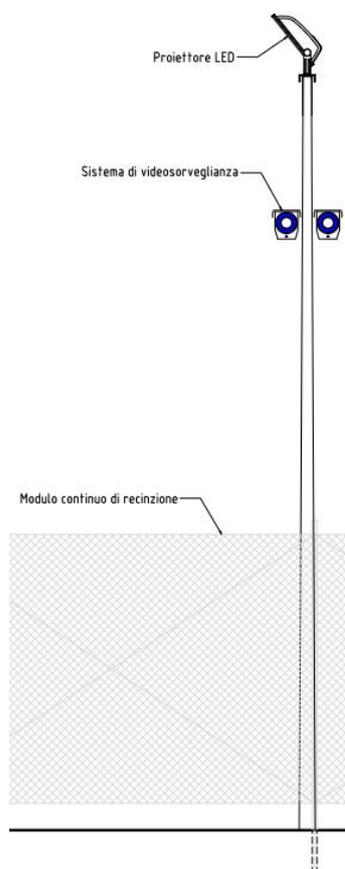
Palo di supporto per corpo illuminante e telecamere
